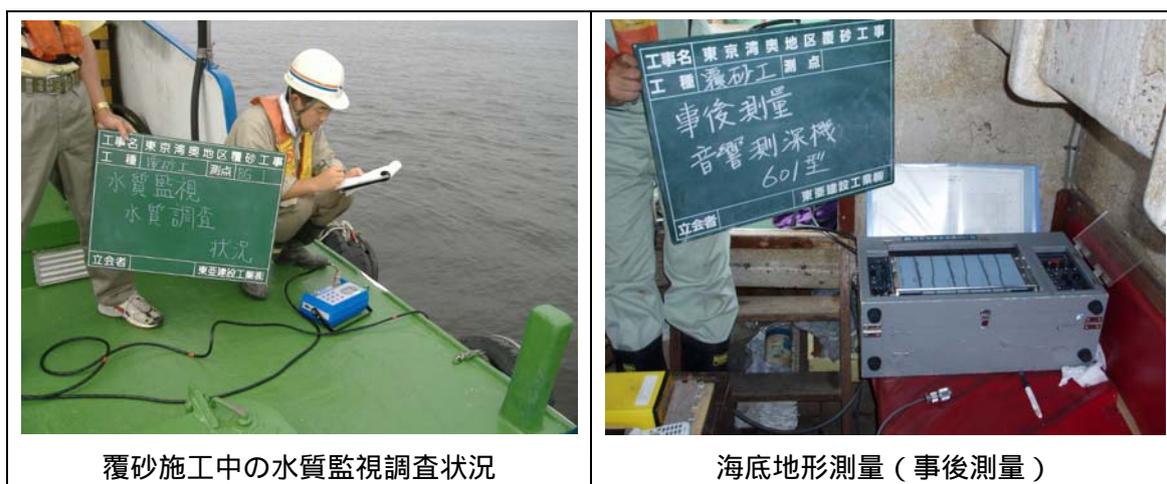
施工中水質監視調査、施工後海底地形測量状況
